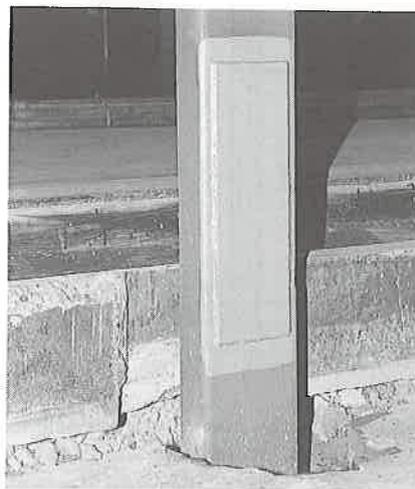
Pilier en acier. La partie rouillée est renforcée par une plaque de fer superposée par soudure.
